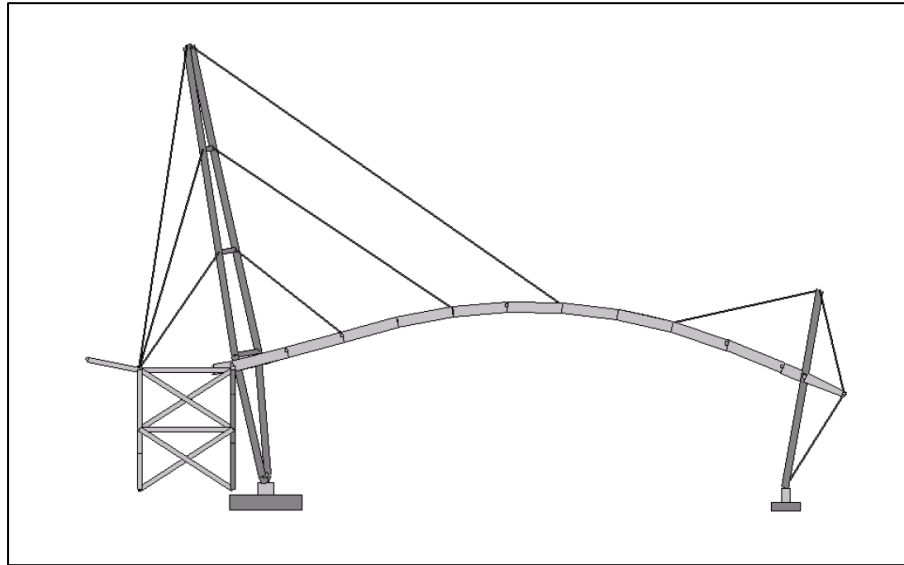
Diagrama Corte de centro atlético de la Universidad de California. Se distingue mástiles de cables y estructura de techo (Design Considerations in Cable-Stayed Roof Structures, David E. Eckmann, Stephanie J. Hautzinger, Thomas R. Meyer).
